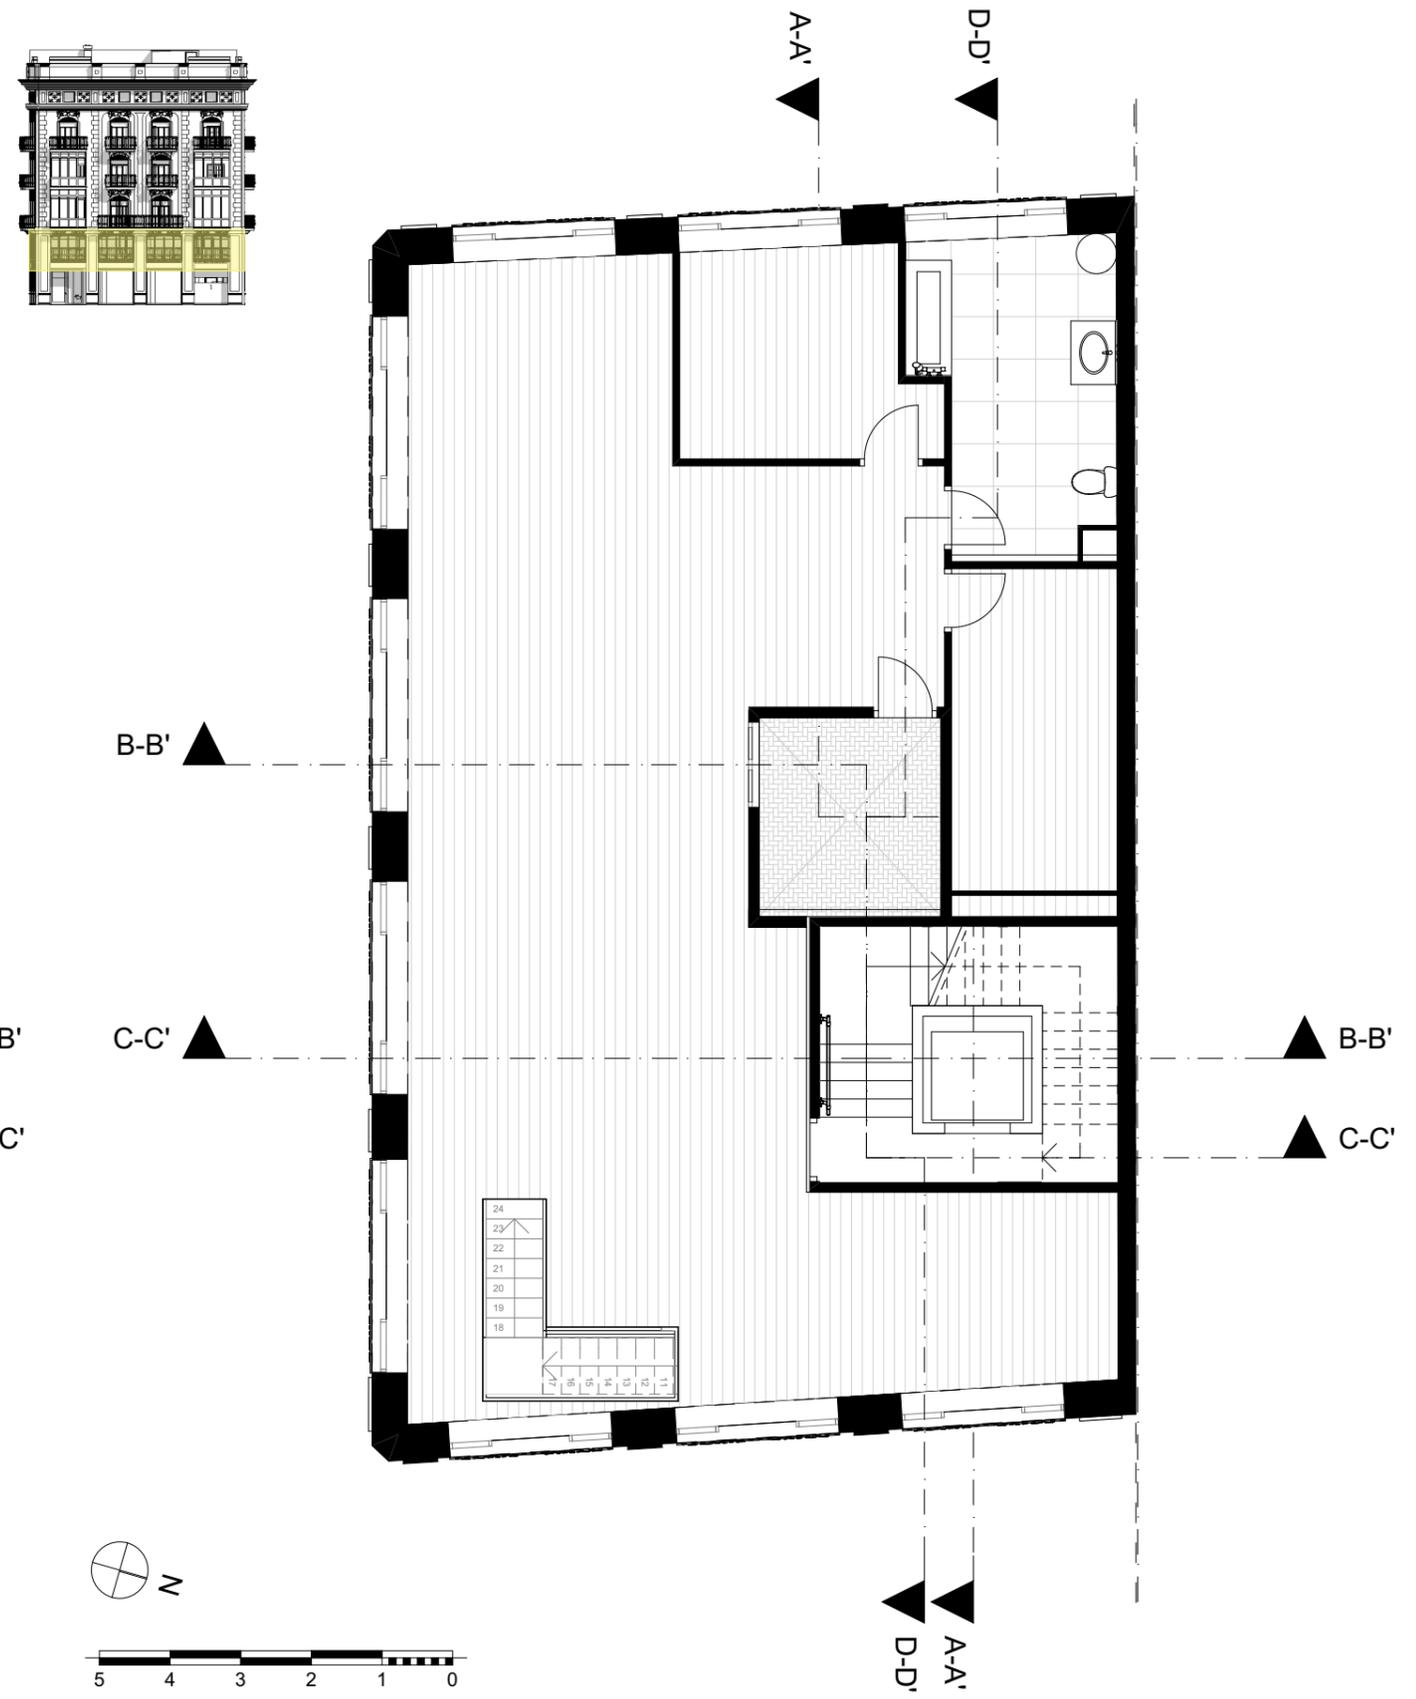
Plano de emplazamiento Edificio Calle de la Paz nº18
